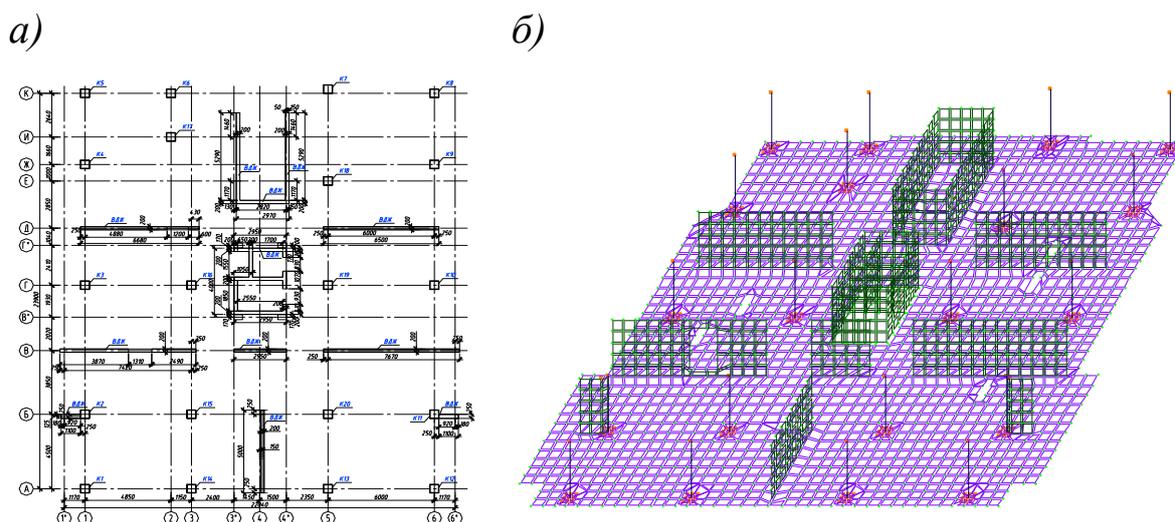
План здания по 1-му варианту (а) и разработанный фрагмент КЭМ
